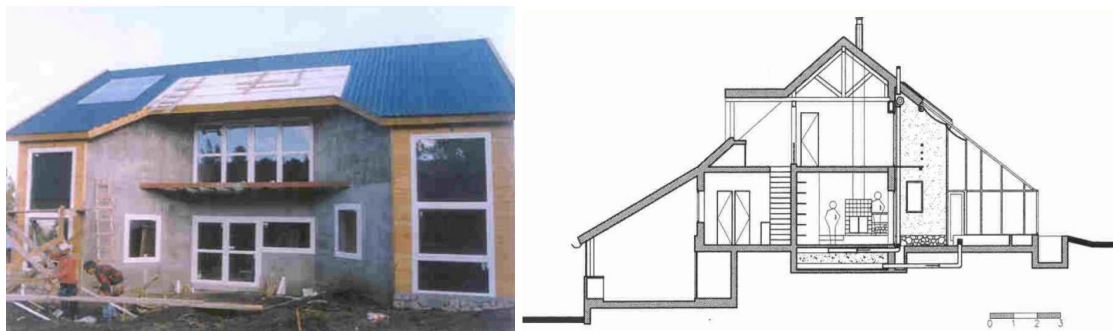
Fachada norte de la vivienda previo al colocado del invernadero (De Schiller, 2005).
